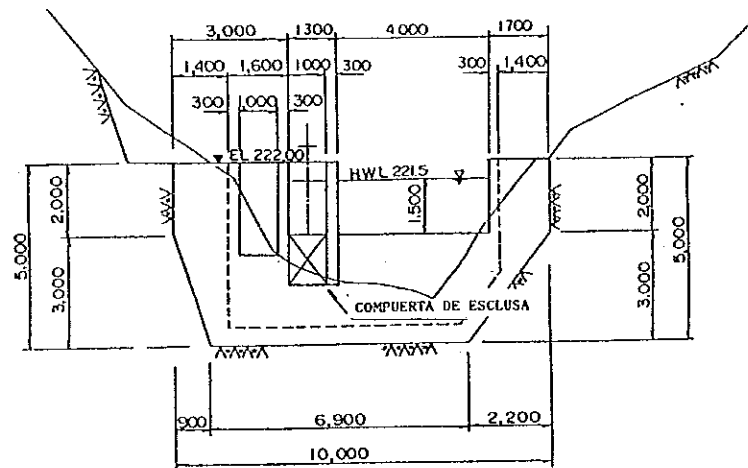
PLANO GENERAL DEL PLAN DE DERIVADORAS (2)
